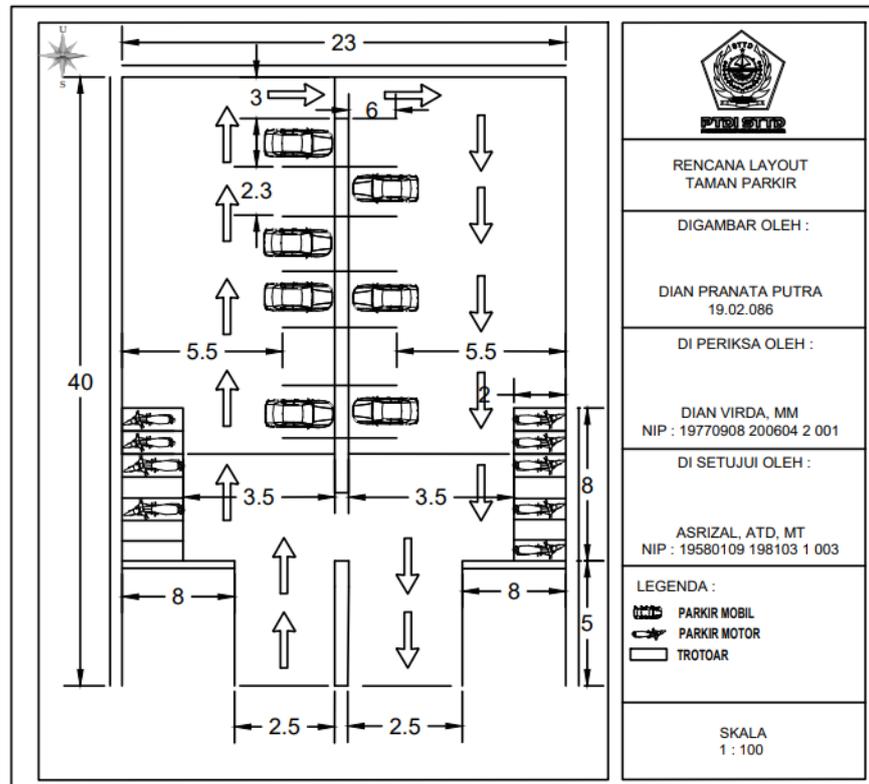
Rencana Lokasi Parkir *Off Street* (Taman Parkir)
